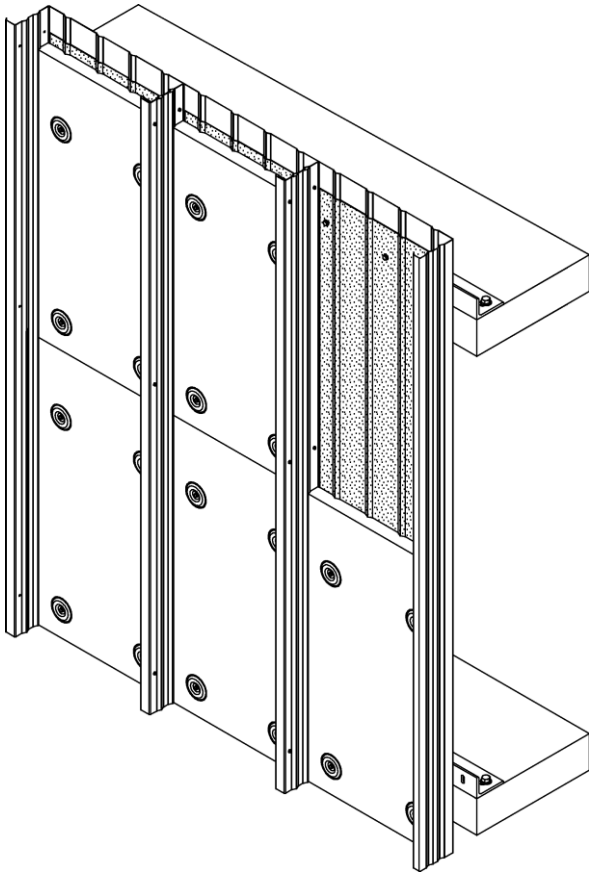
Detalle de la posición del panel aislamiento exterior.
